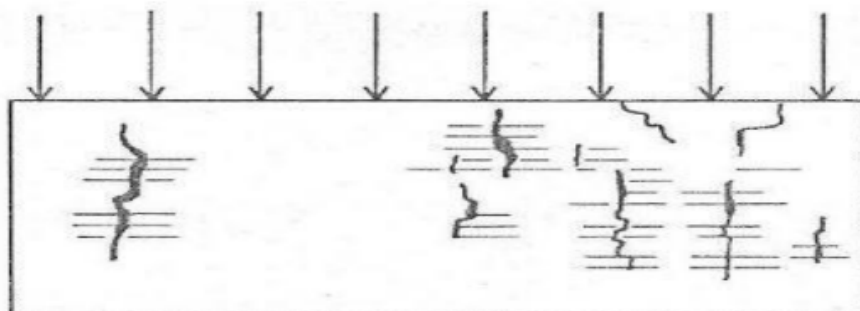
Fissuras em vigas de concreto armado por flexão e cisalhamento
